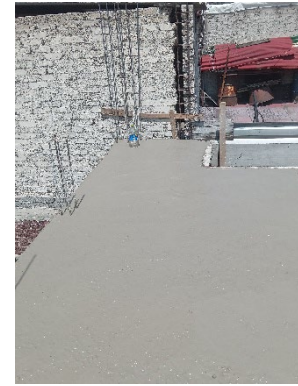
Foto de viga y bovedilla colocada al ras de la cadena de cerramiento.
